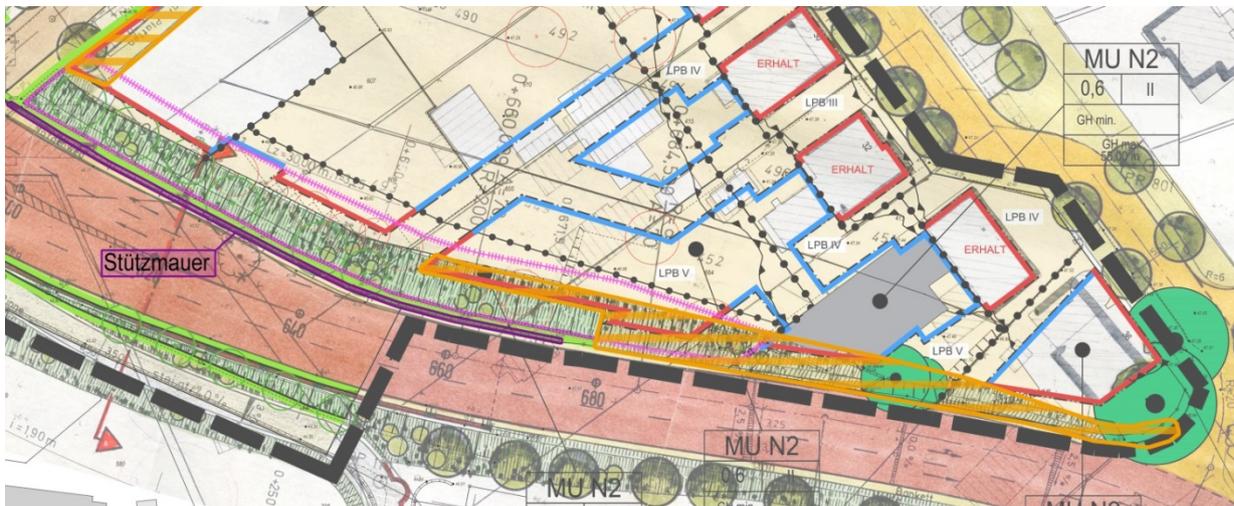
Kerntangente – Planfeststellungsbeschluss und Bebauungsplan
